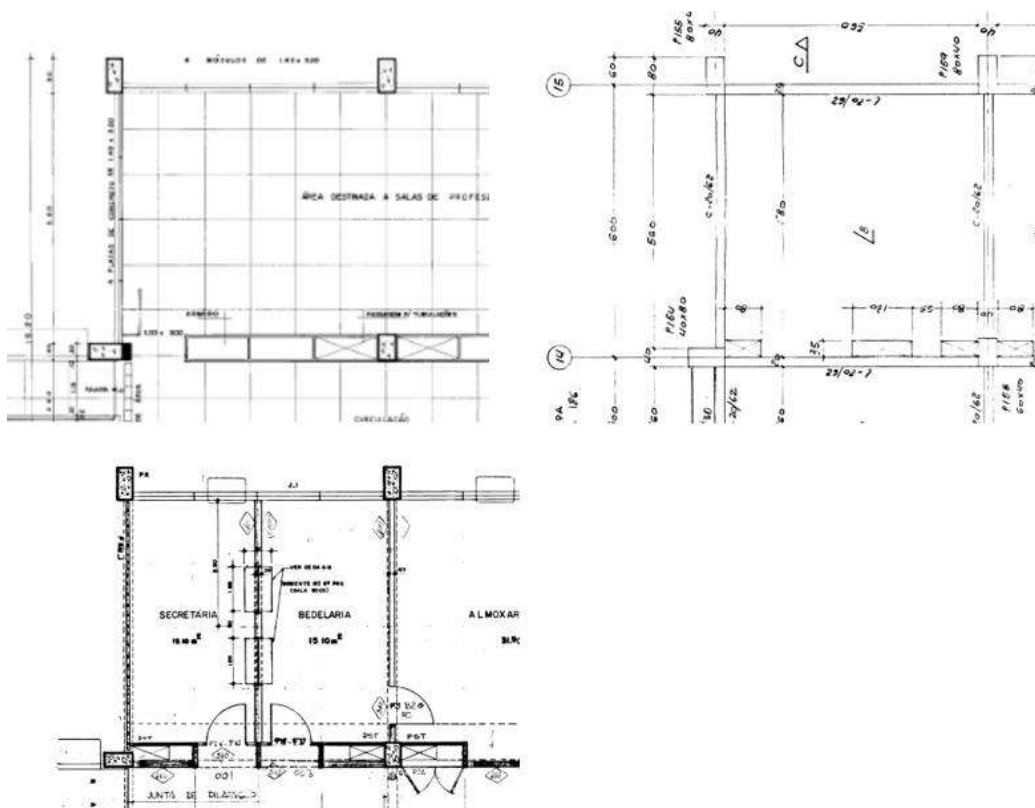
UERJ. Conjunto Escolar. Pavimento Tipo. Ampliação de trechos do desenho de arquitetura definitivo, desenho de arquitetura para obra e planta de fôrmas. Blocos H,I.
